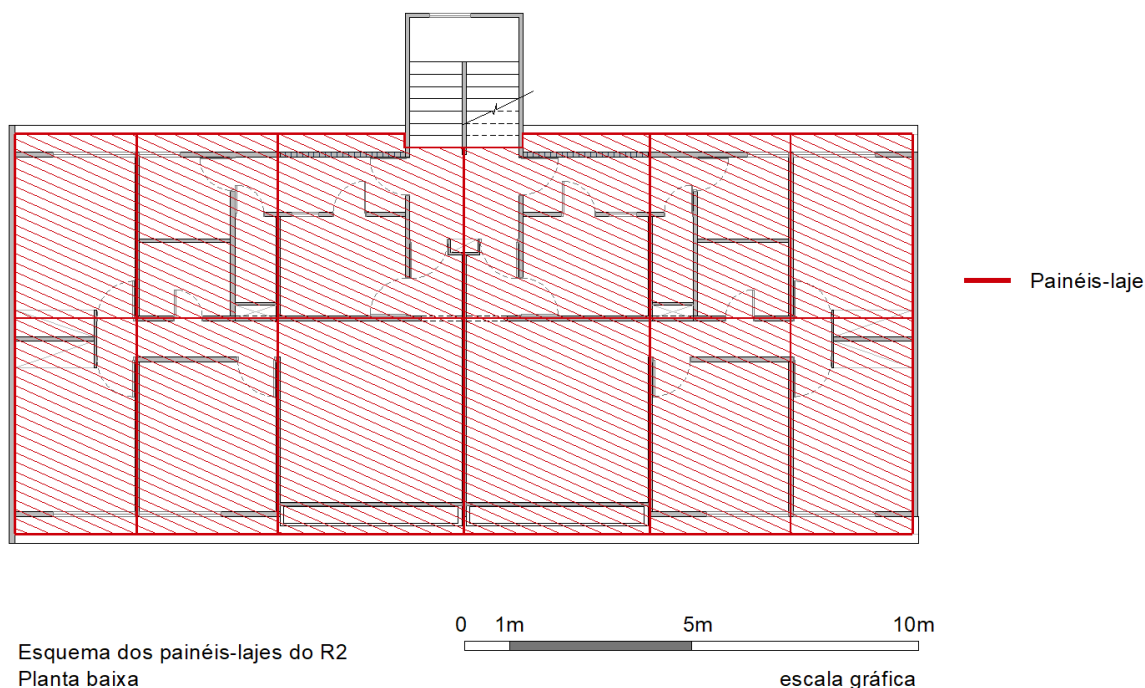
Esquema com posicionamento das lajes pré-fabricadas do R2. Fonte: da autora.
